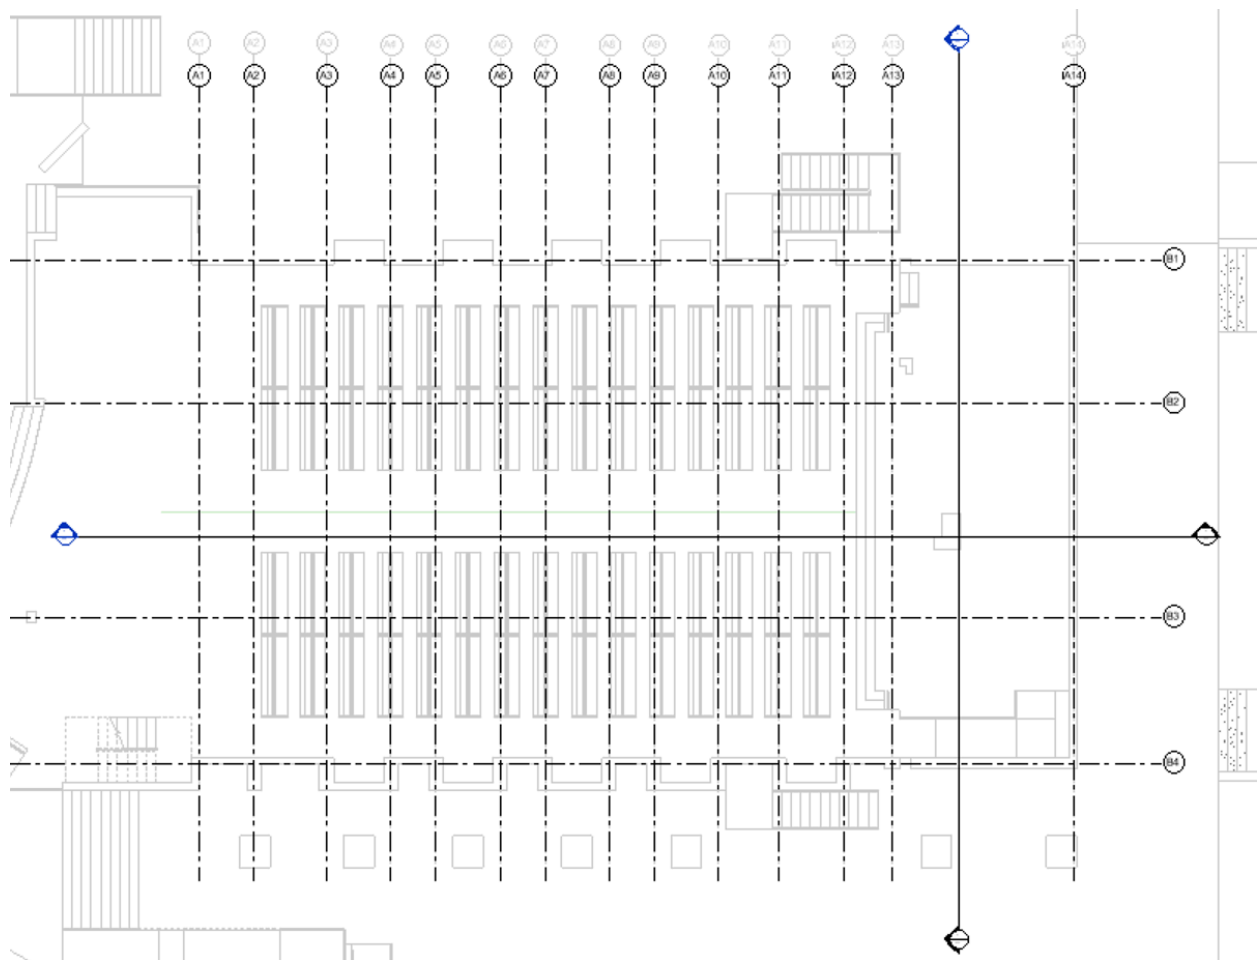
Secciones longitudinal y transversal sobre la Planta Acceso
